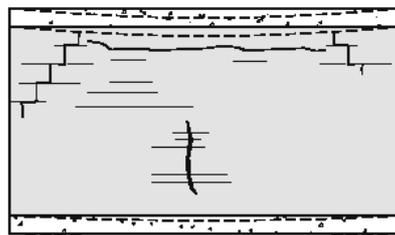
Fissuras em parede de vedação: deformação do suporte inferior à deformação da viga superior
